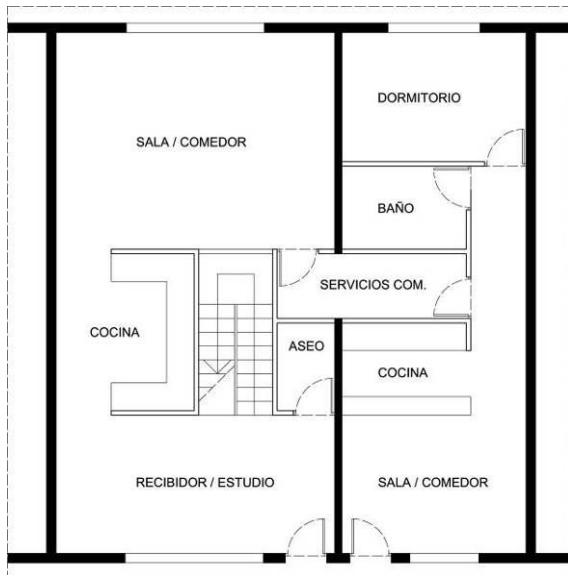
Modelo Vivienda canguro. Planta baja de dos viviendas adosadas.
